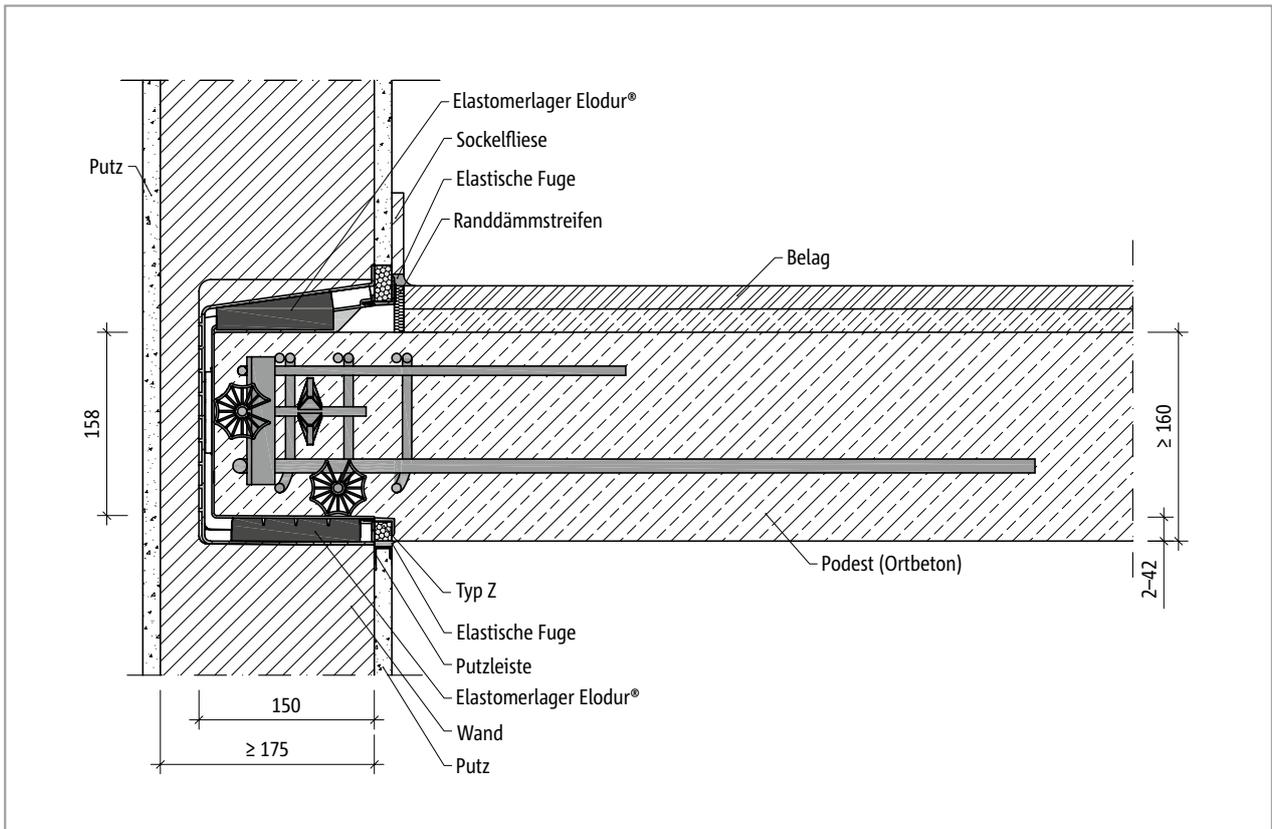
Schöck Tronsole® Typ Z-V+V-T: Einbauschnitt Ortbetonpodest
